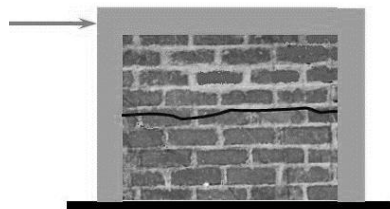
Falla por deslizamiento en muro de mampostería no estructural (Masias, 2002).
